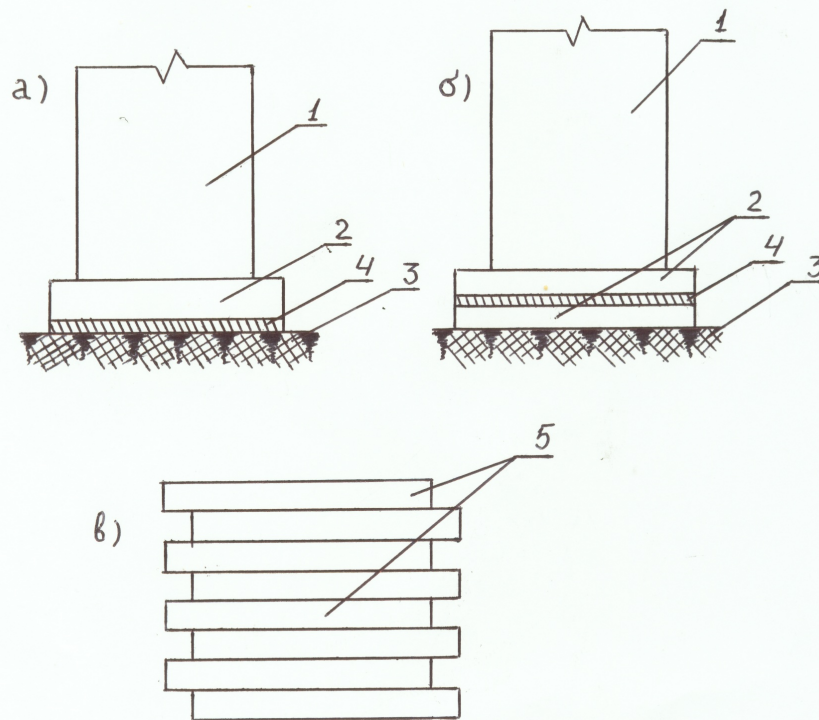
Сейсмоизоляционные маты из протекторных обрезков утилизированных металлокордных покрышек: а) расположение сейсмоизоляционного мата между фундаментом и основанием здания; б) расположение сейсмоизоляционного мата внутри фундамента здания; в) собранный элемент мата; 1 – здание; 2 – фундамент; 3 – грунтовое основание; 4 – сейсмоизоляционный мат; 5 – протекторные полосы, соединенные в отдельный элемент мата
